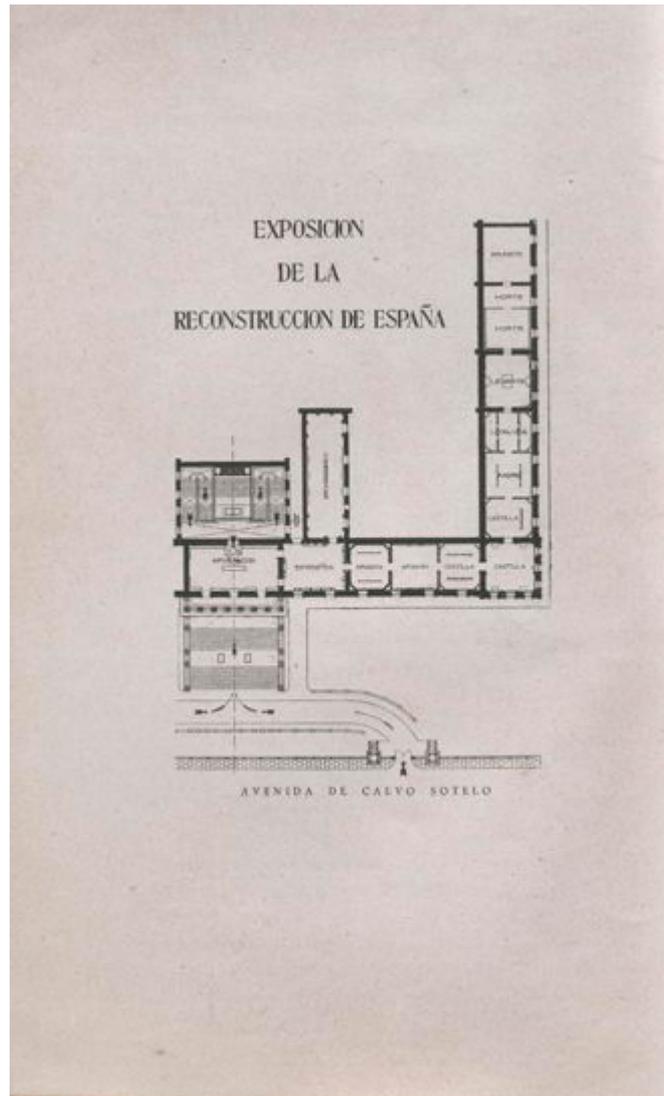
Planta de la exposición sobre la Reconstrucción en España encaminada a hacer visible la labor reestructora y a utilizarla con fines propagandísticos.
